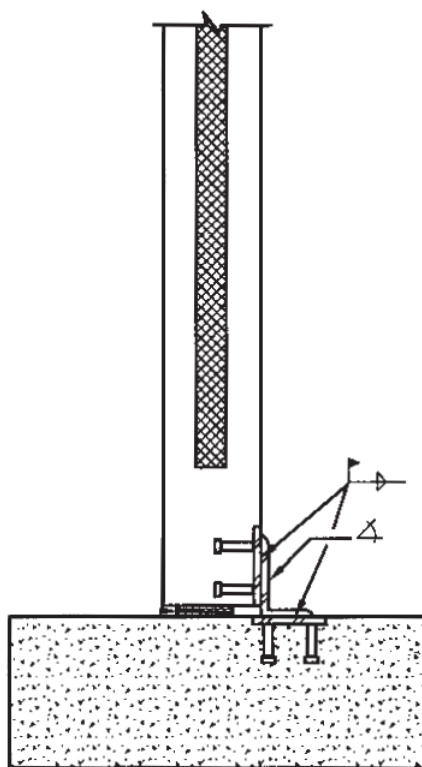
Ligação painel sandwich - fundação por soldadura, adaptado de [20]
